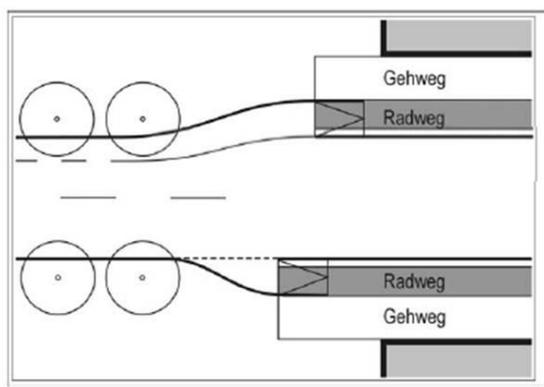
Übergang Radweg auf Schutzstreifen mittels Rampe [6]
